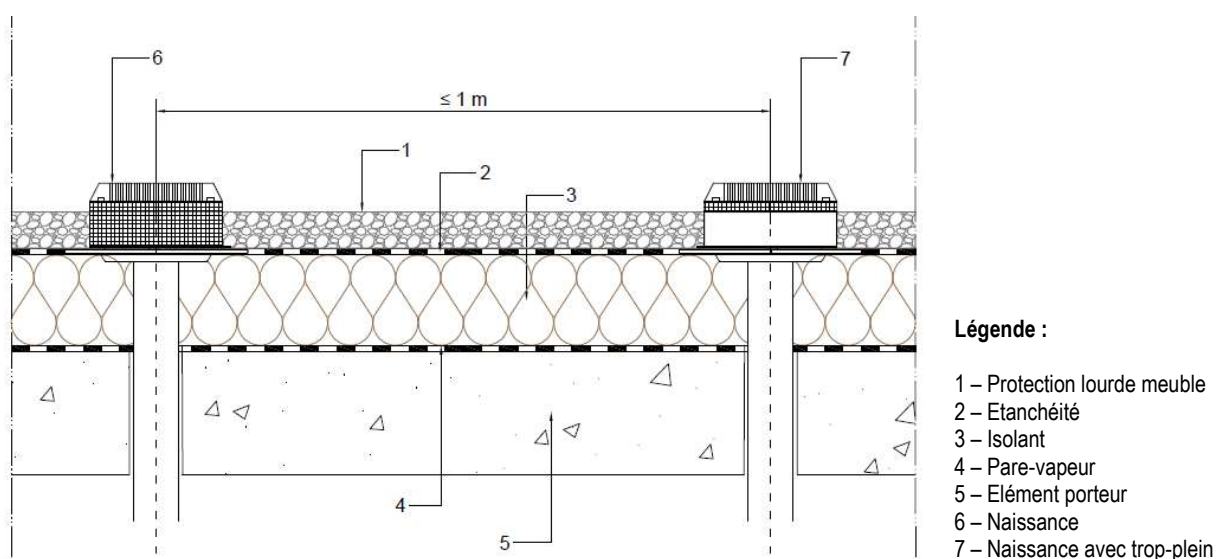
Maçonnerie - Mise en place d'un Réseau Secondaire sur toiture-terrasse étanchée avec protection lourde meuble
